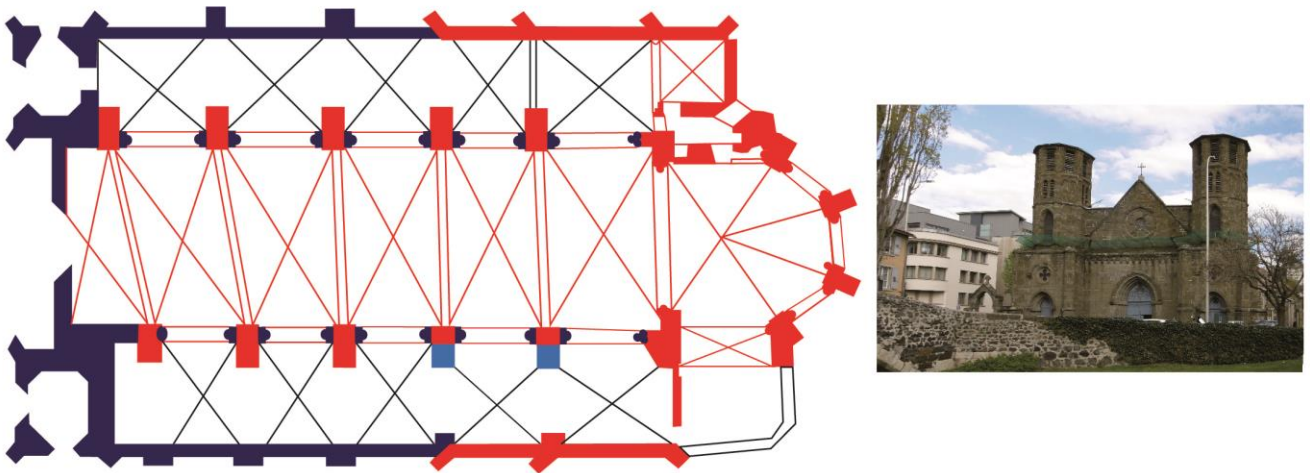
Plan avec les espaces de pouvoirs de la ville basse – XIII^e- XV^e siècles. M. Bizri
